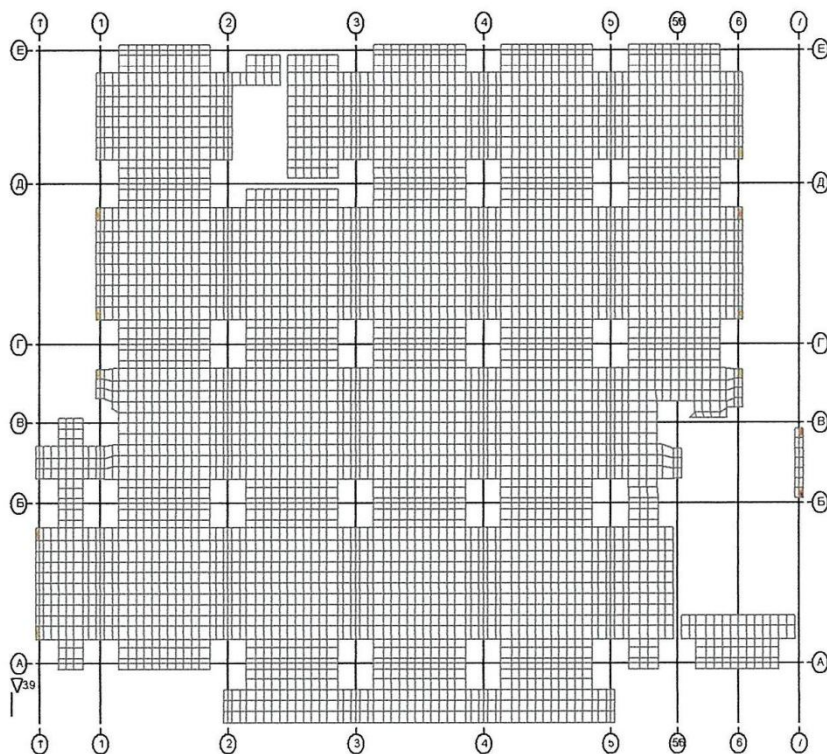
Поперечна арматура у напрямку вісі Y (ASW2) у плитах
